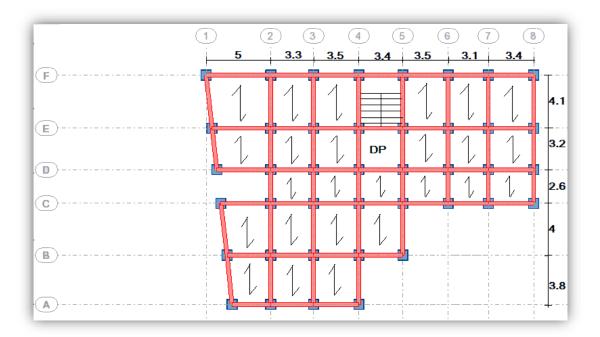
vue en plan du plancher et la disposition des poutrelles
